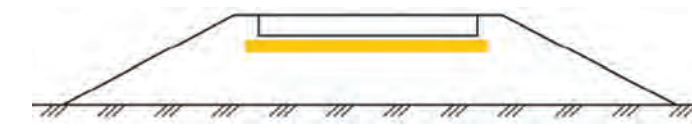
Защита основной площадки железнодорожной насыпи от таяния листами пенополистирола
